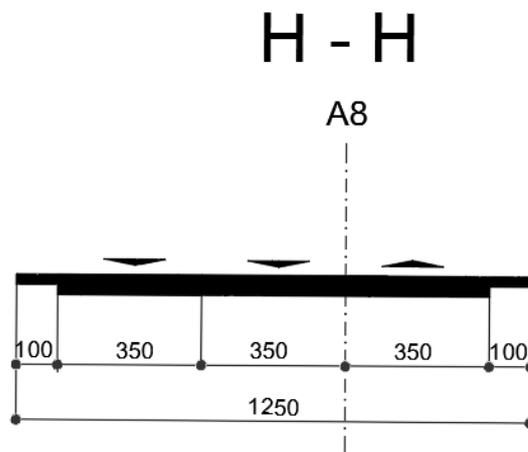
Esempio sezione stradale utilizzata per accesso ad AFA dalla tangenziale, misure in cm
